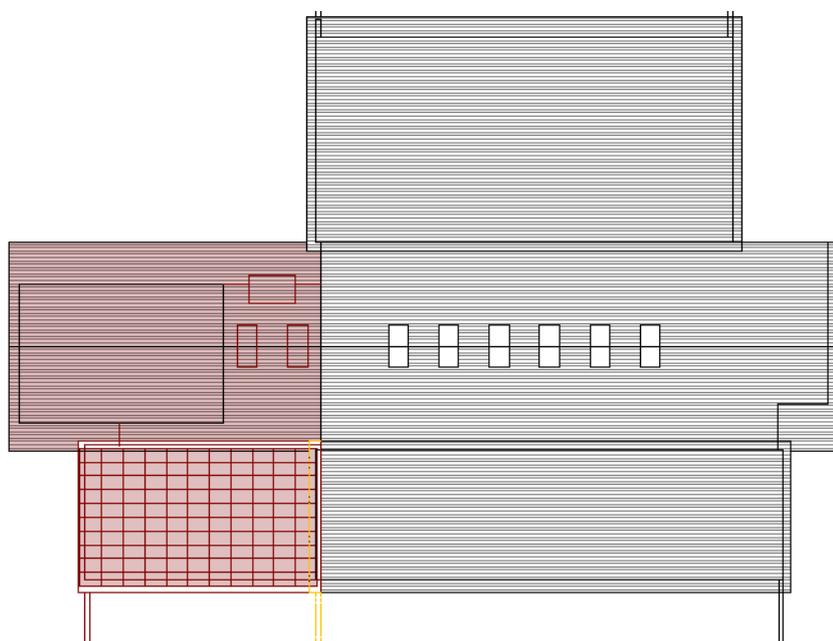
Erdgeschoss, Plan-Massstab vernachlässigt – Erweiterungsbau mit ausgebauter Eingangshalle.
